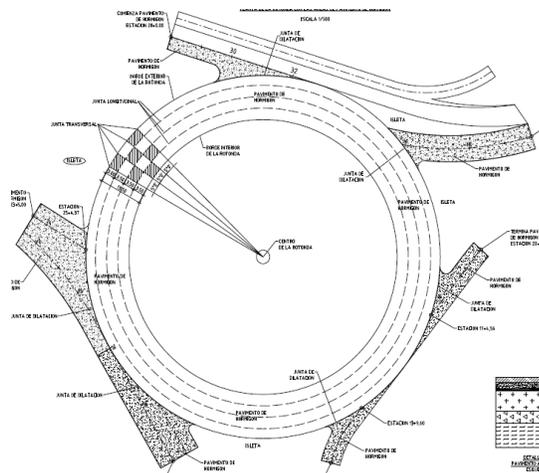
Rotonda de la entrada a Varadero de pavimento de hormigón hidráulico
